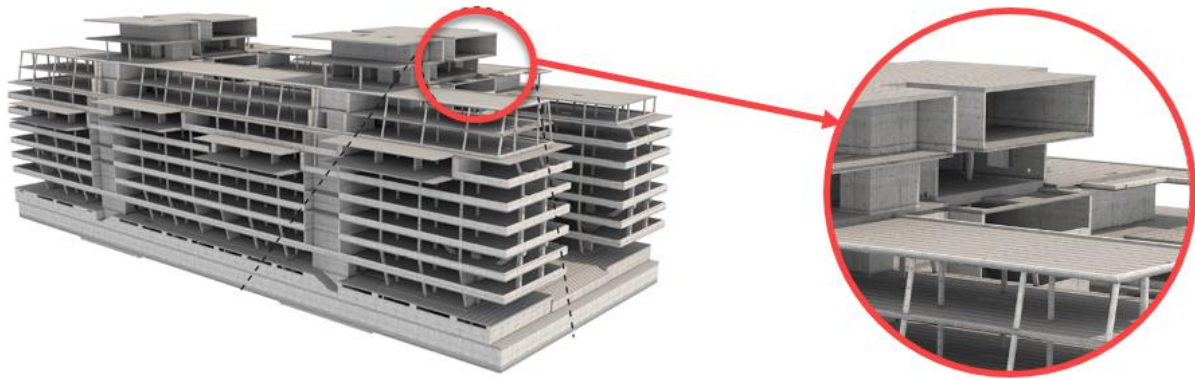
Schalungsmodell eines Stahlbetongebäudes [13]
